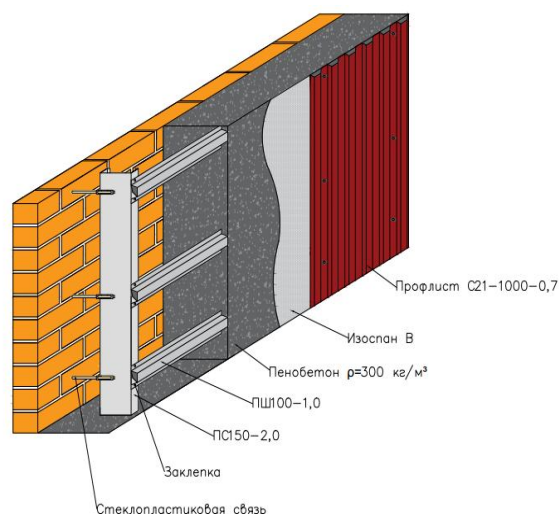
Фасадная система из пенобетона и металлического профилированного листа
